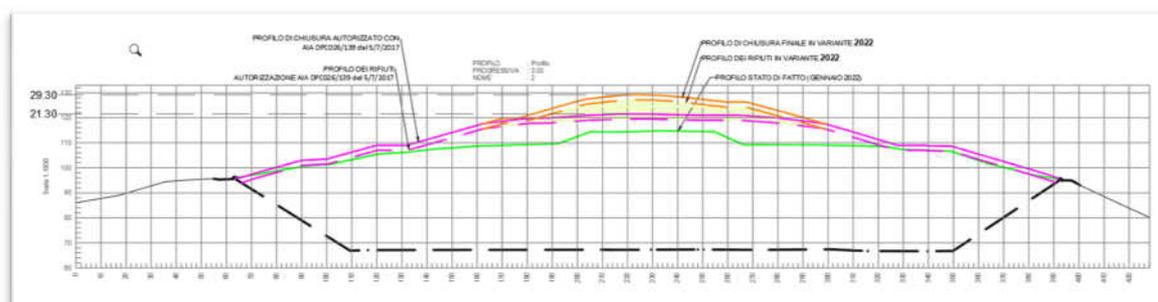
Sezione di progetto modifica profilo di chiusura finale
